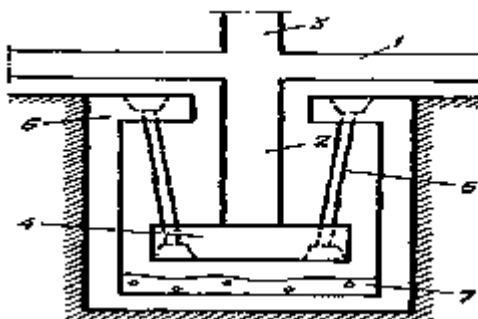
Сейсмоизолирующий фундамент с подвесными опорами: 1 – ростверк; 2 – опора под колонну; 3 – колонна; 4 – плита под опорой; 5 – преднапряженный железобетонный трос; 6 – верхняя плита колодца; 7 – слой песка.
